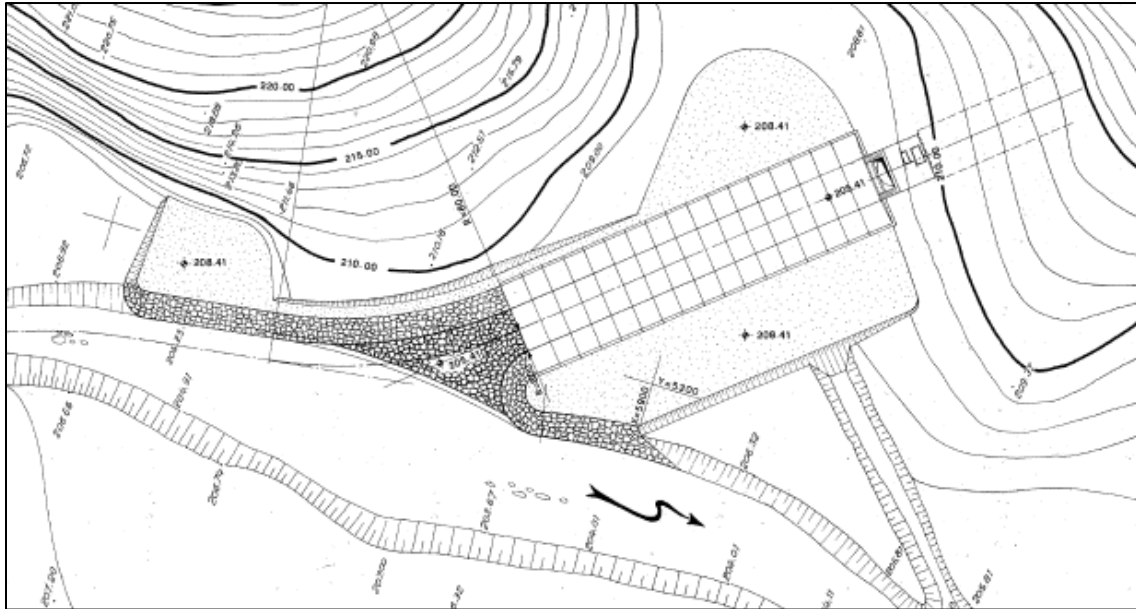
Opera di imbocco scarico di fondo - Planimetria
